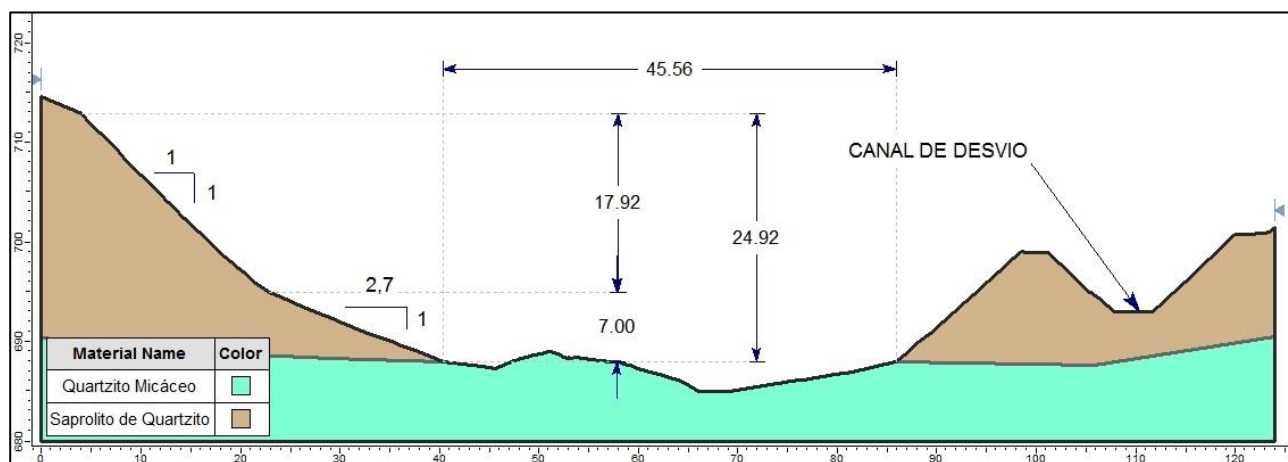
Perfil geológico-geotécnico da seção da Estaca 4+0,00 m da escavação realizada para as obras de limpeza de fundação do Dique S4.
